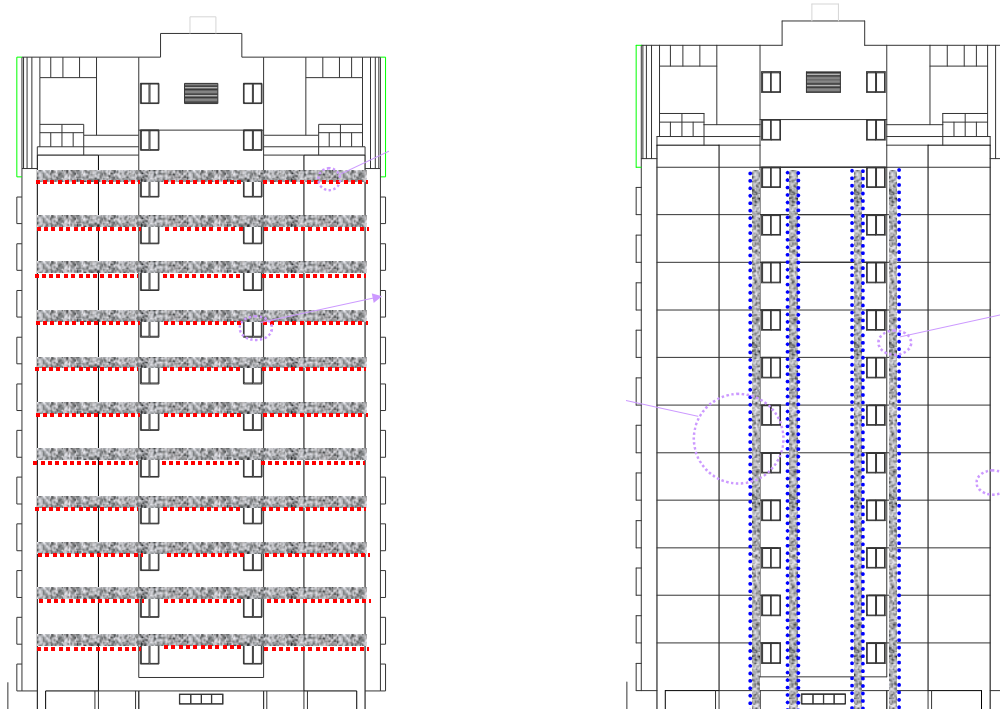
Detalhamento da juntas horizontais e verticais do edifício avaliado.
